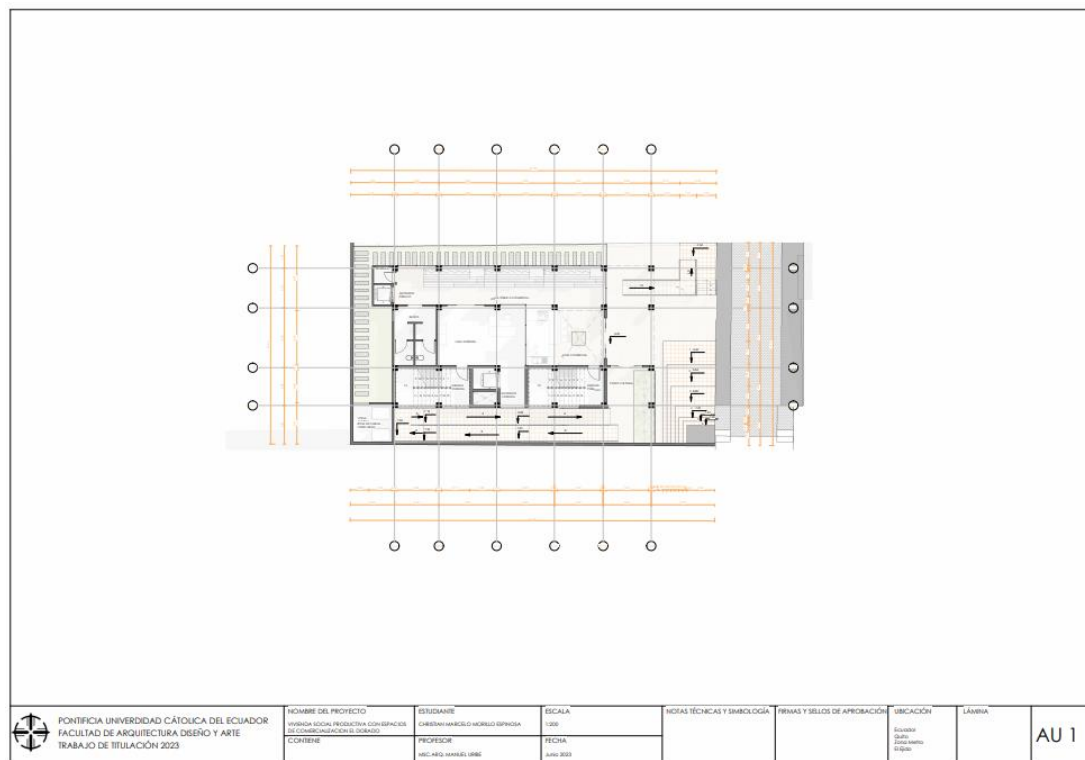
Segunda intervención- Planta Baja. (Morillo C. 2023)
